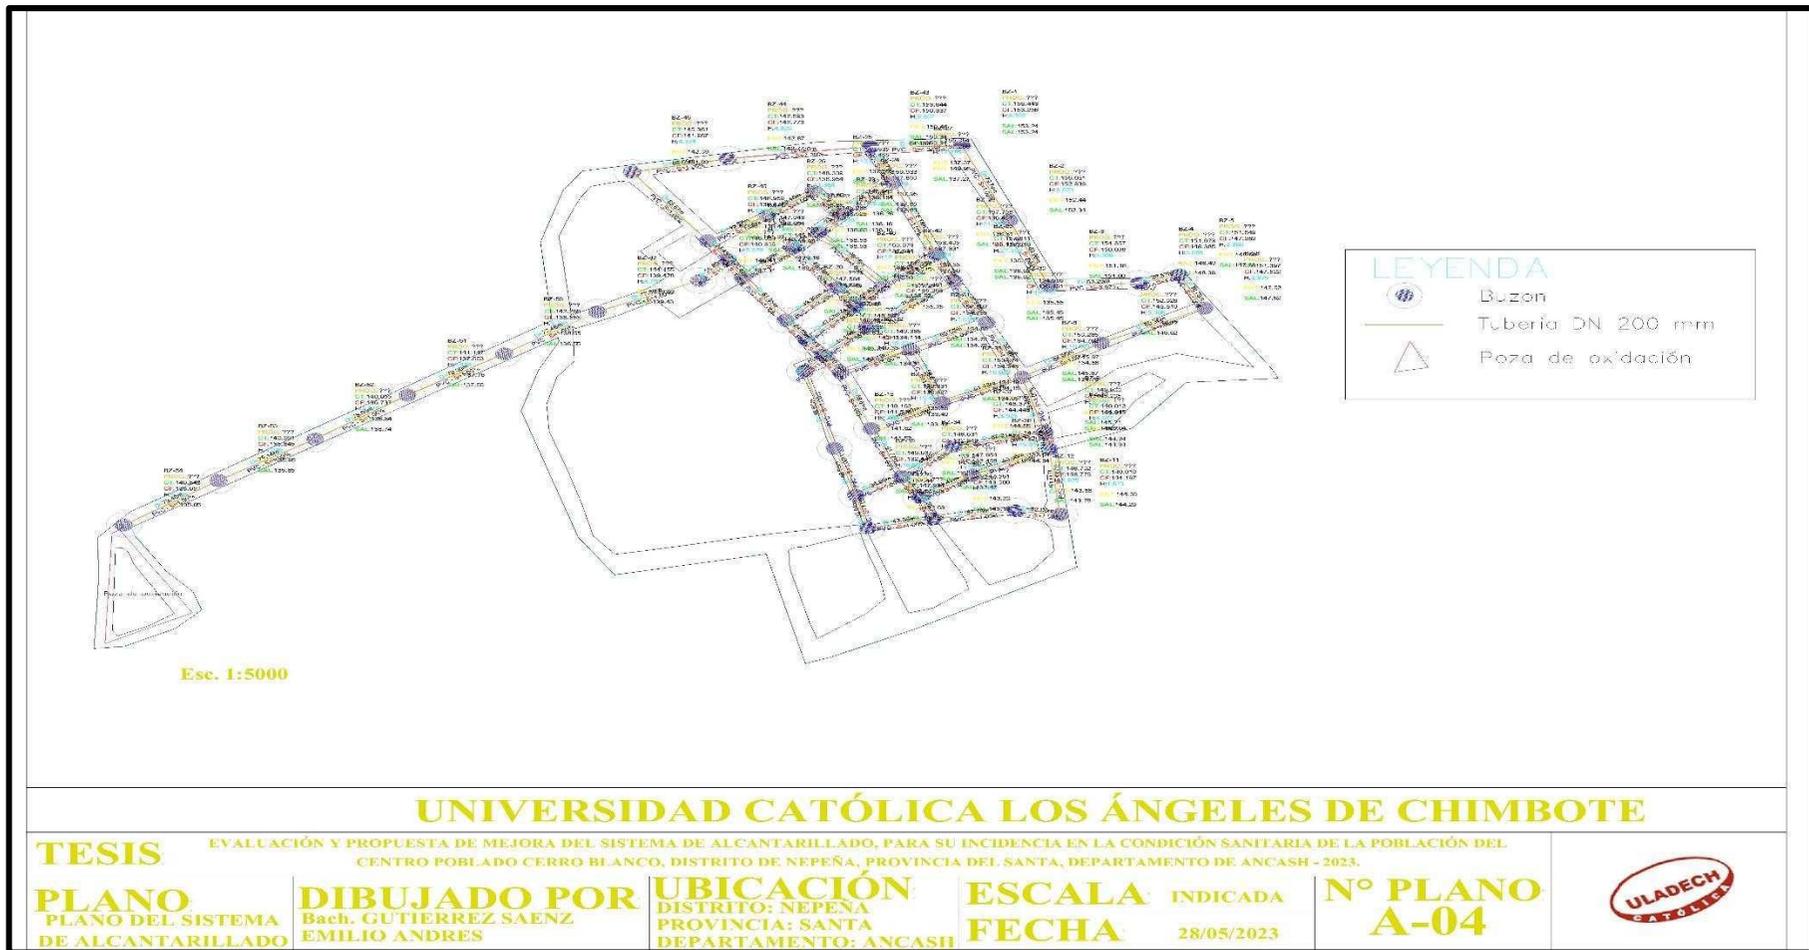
Plano de la red de alcantarillado del centro poblado Cerro Blanco
